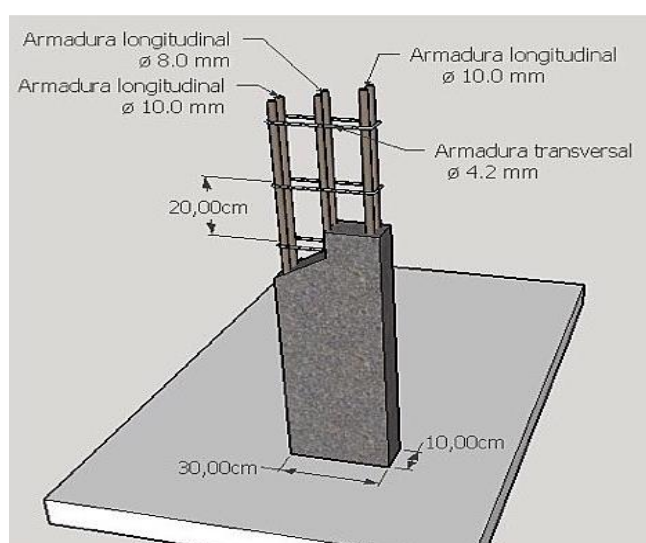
Caso 01 – Esquema de posicionamento das armaduras dos pilares do pavimento térreo.
